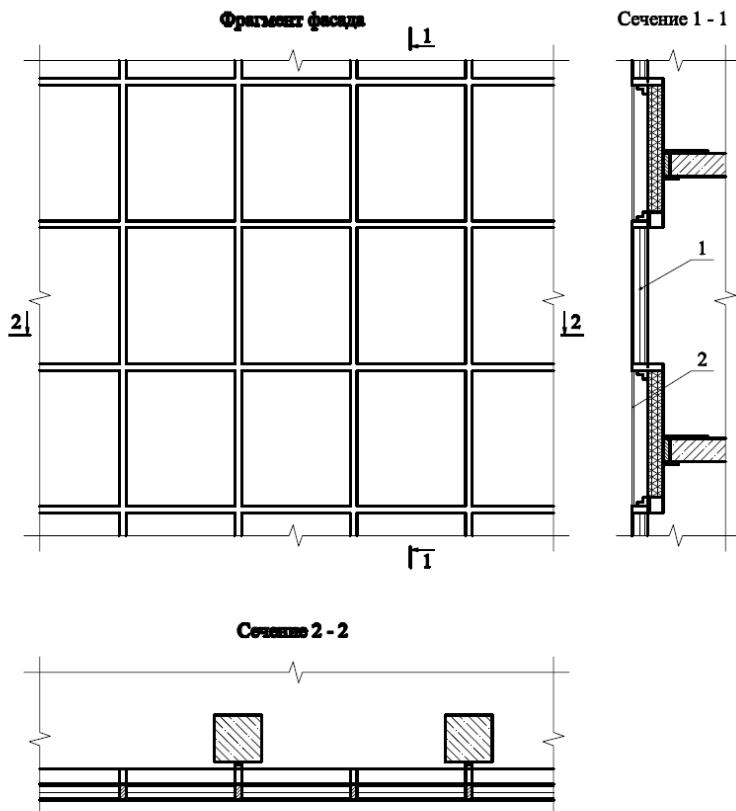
Фасад с остеклением глухих участков наружных стен:
